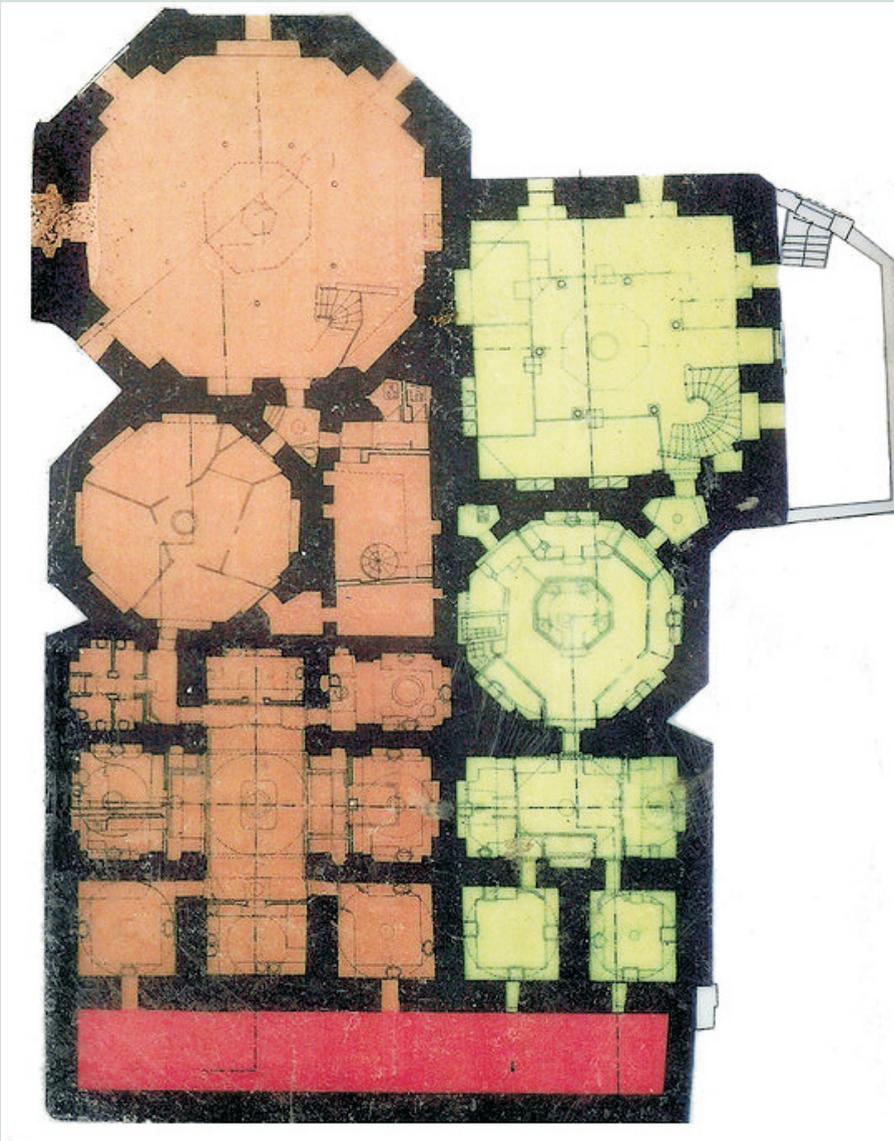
Grundriss des Bey-Hammams in Bursa (1444)
